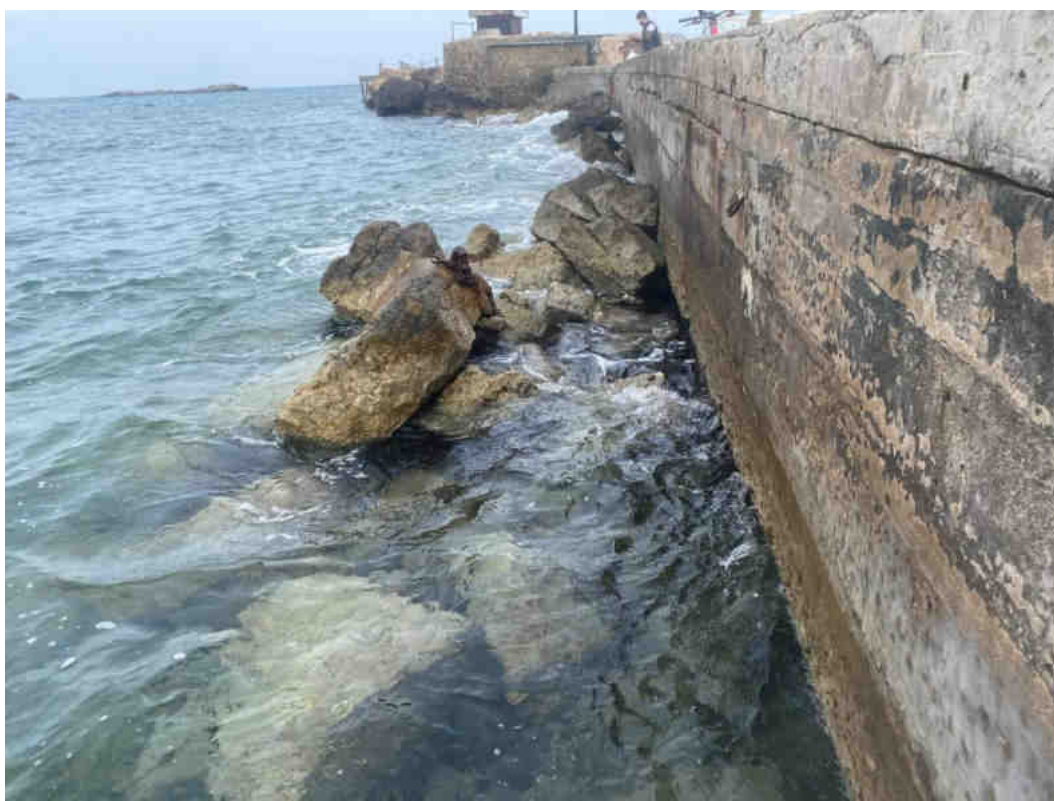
Exterior del dique de abrigo, en buen estado estructural.
